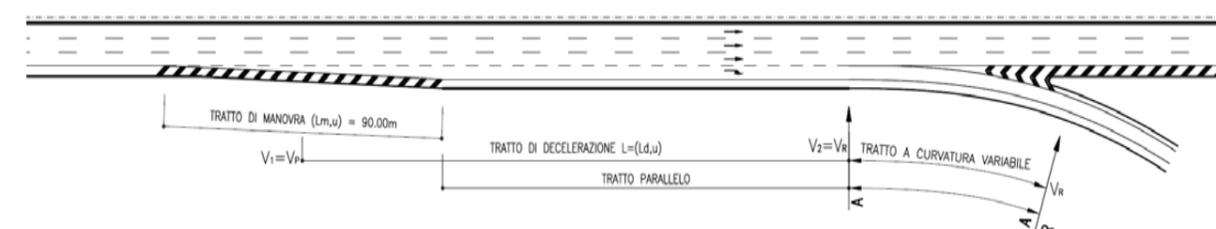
Schema planimetrico corsia di uscita (diversione) - tipologia parallela
